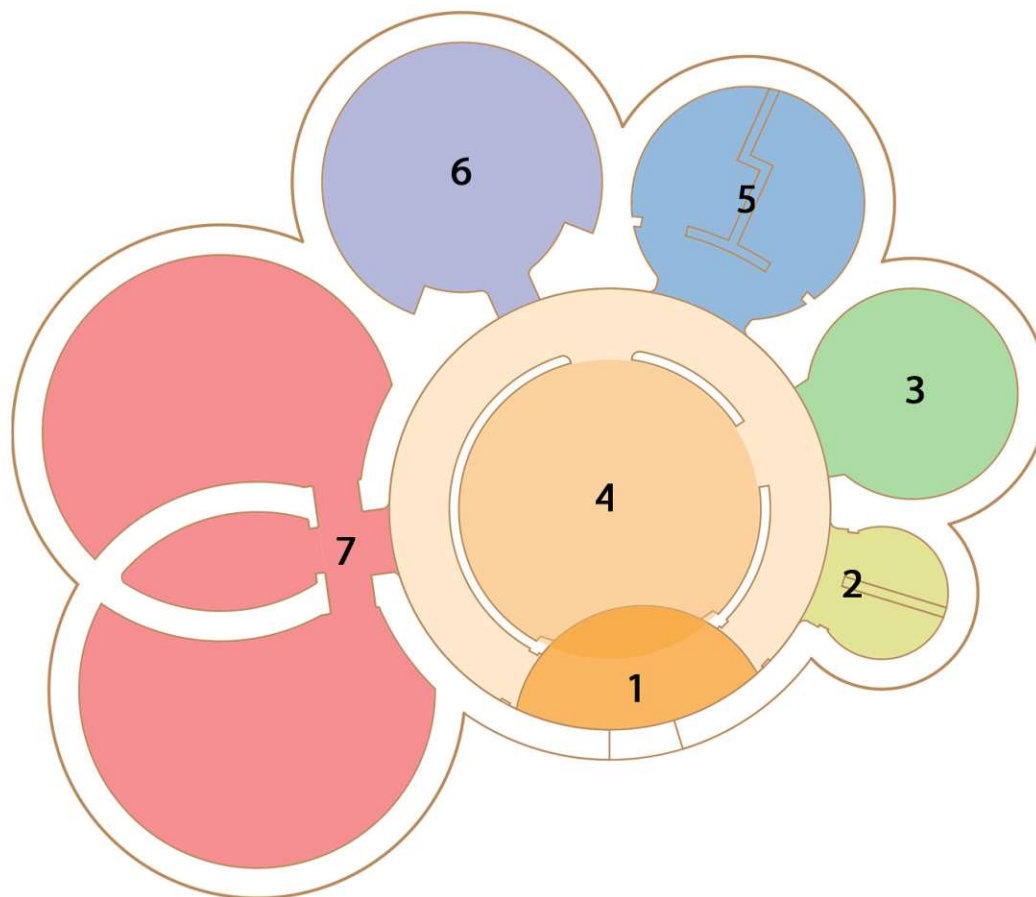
Geometrische Beziehungen im Grundriss
